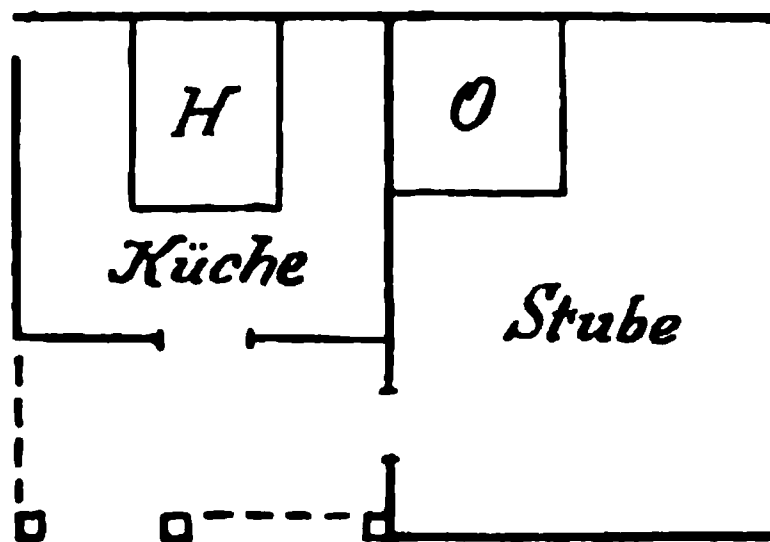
a. Grundriss eines kroatischen Häuschens mit offenem Eckflur.
